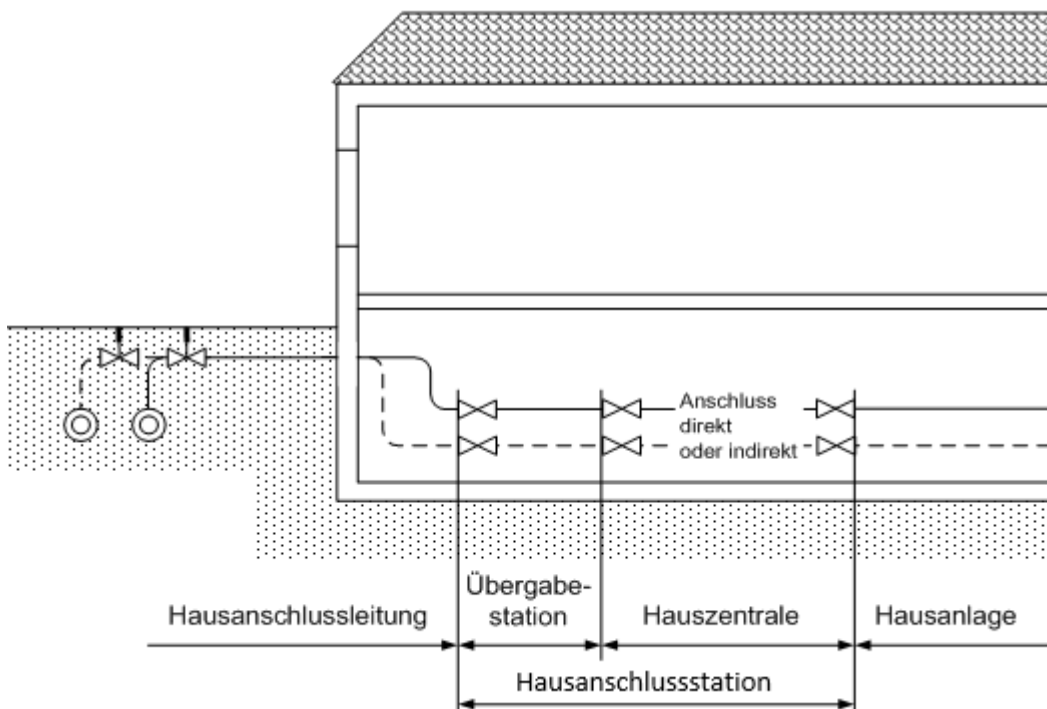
Hausanschlussleitung und Hausanschlussstation
